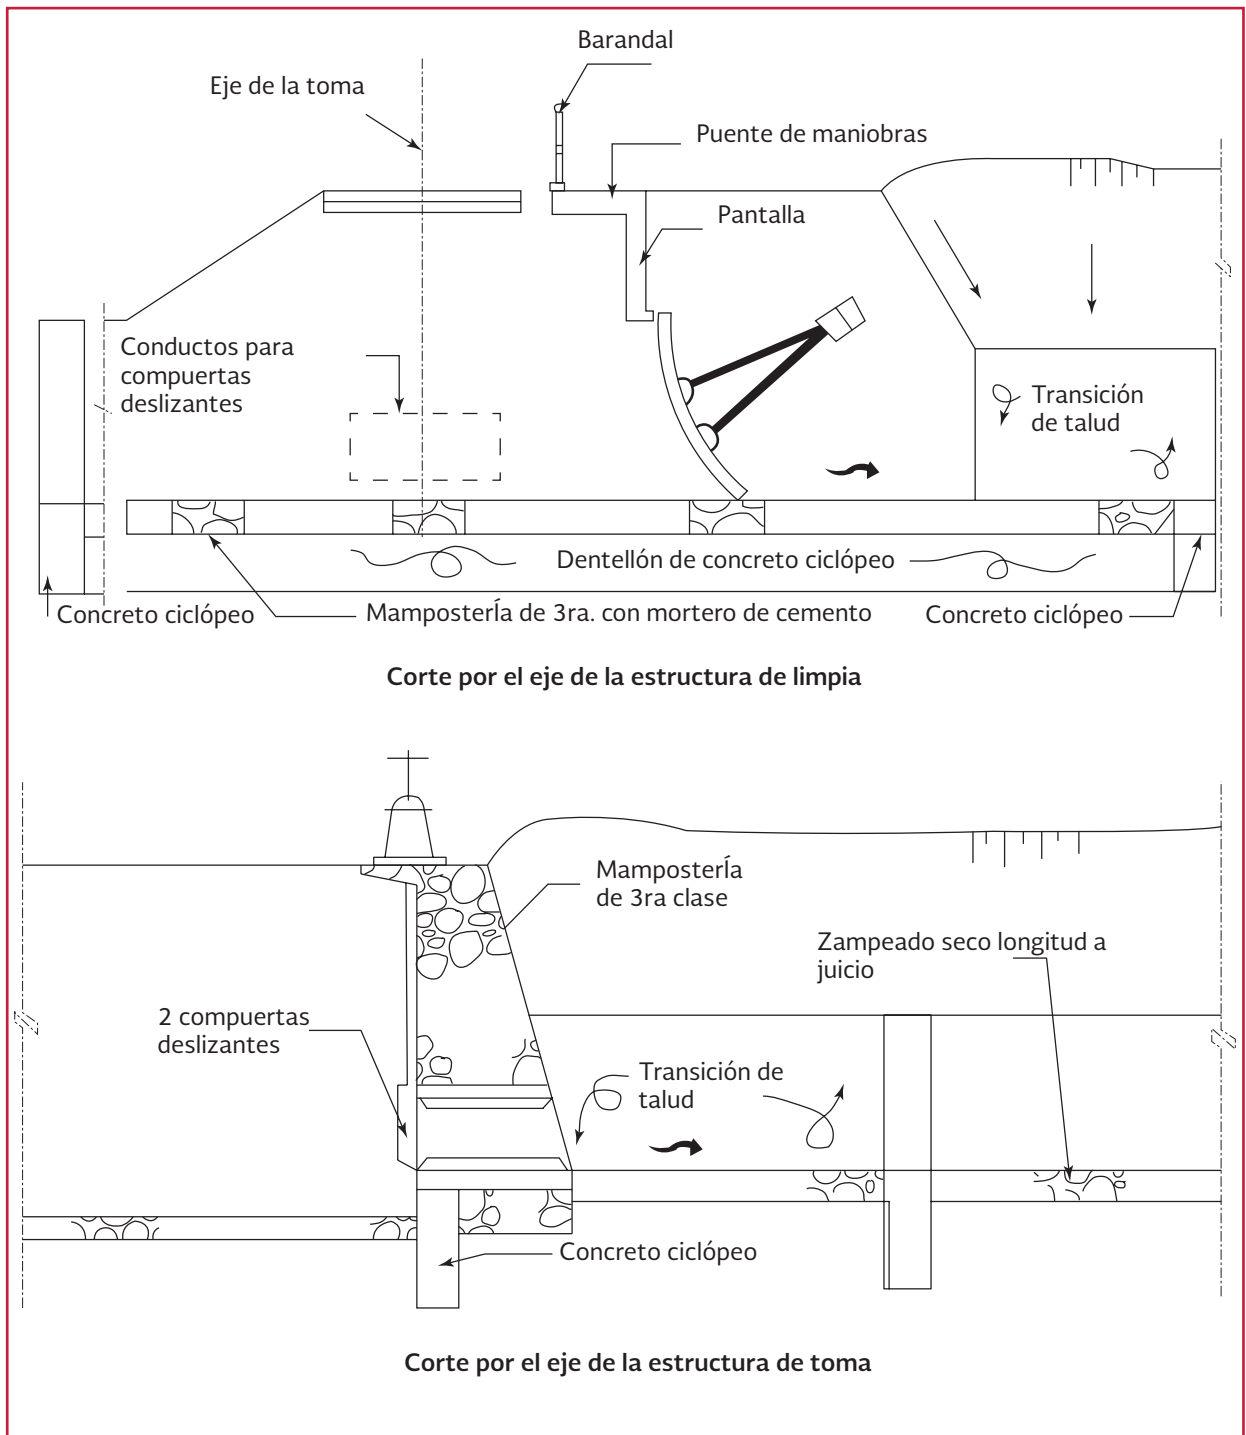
Obra de toma con compuerta deslizante y conducción a un canal
